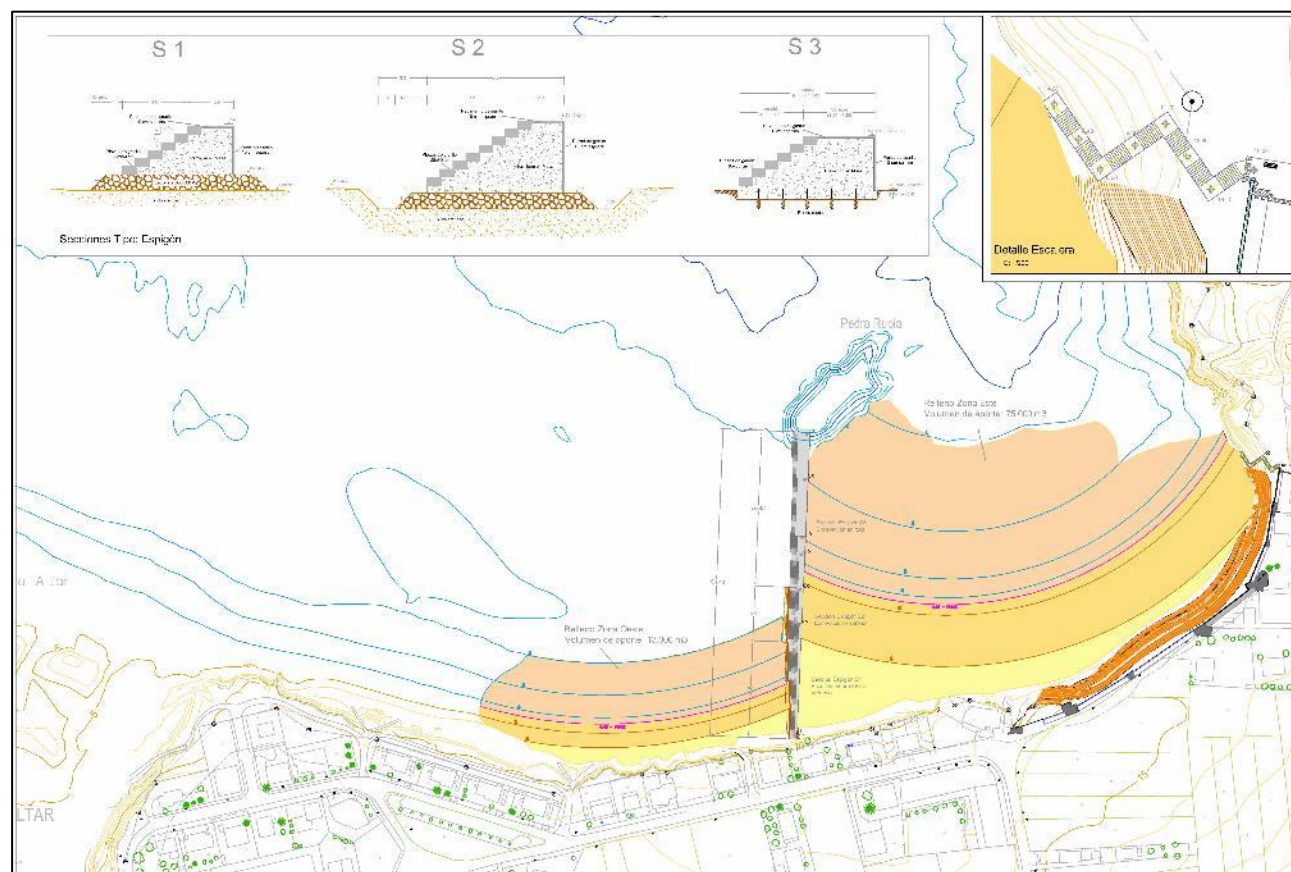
Planta general de las obras; Relleno, espigón y escalera
